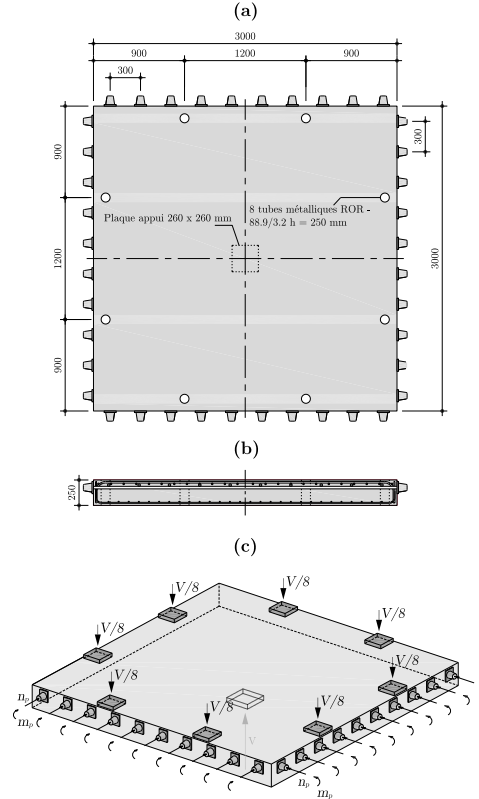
Dimensions des dalles d'essais au poinçonnement chargées par un effort normal de compression: (a) Plan, (b) Coupe et (c) Schéma simplifié du principe de chargement
